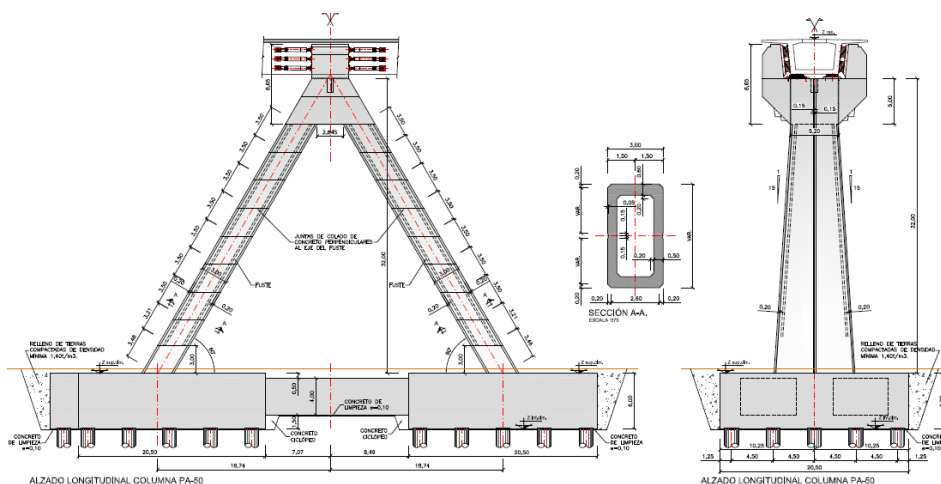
Alzado longitudinal y transversal y sección de pila delta.
